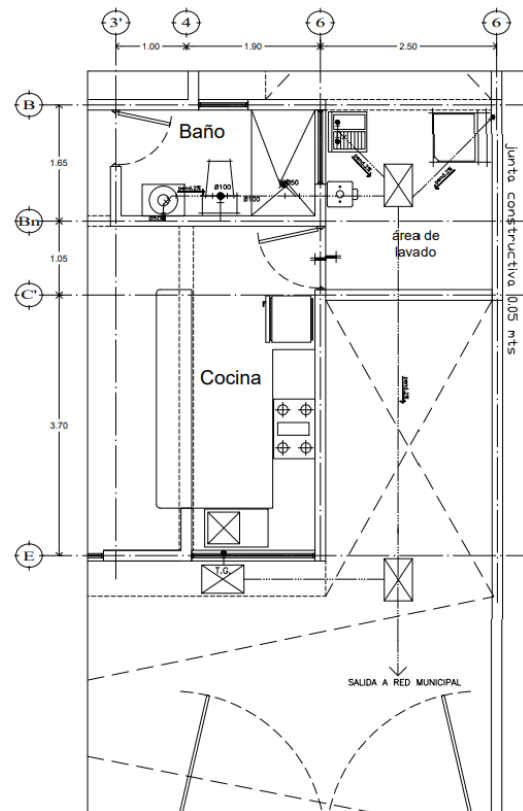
Propuesta de instalación sanitaria, caso Leticia Navarro Alfaro. Elaboración propia.
